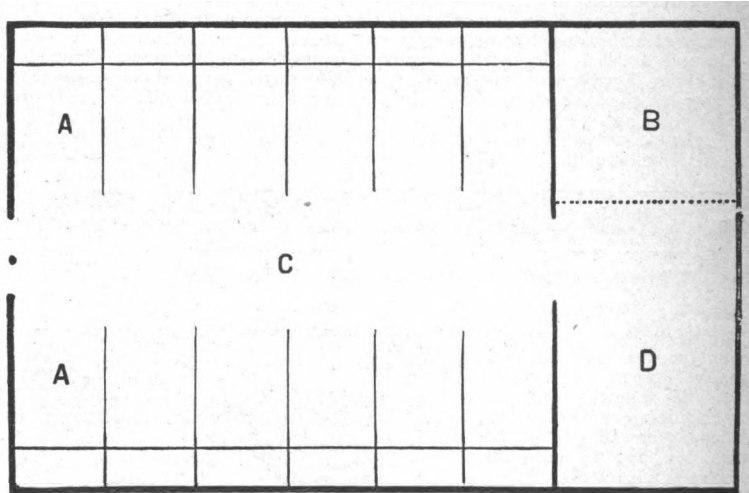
Plan d'une grande écurie. Les chevaux sont placés tête au mur.
